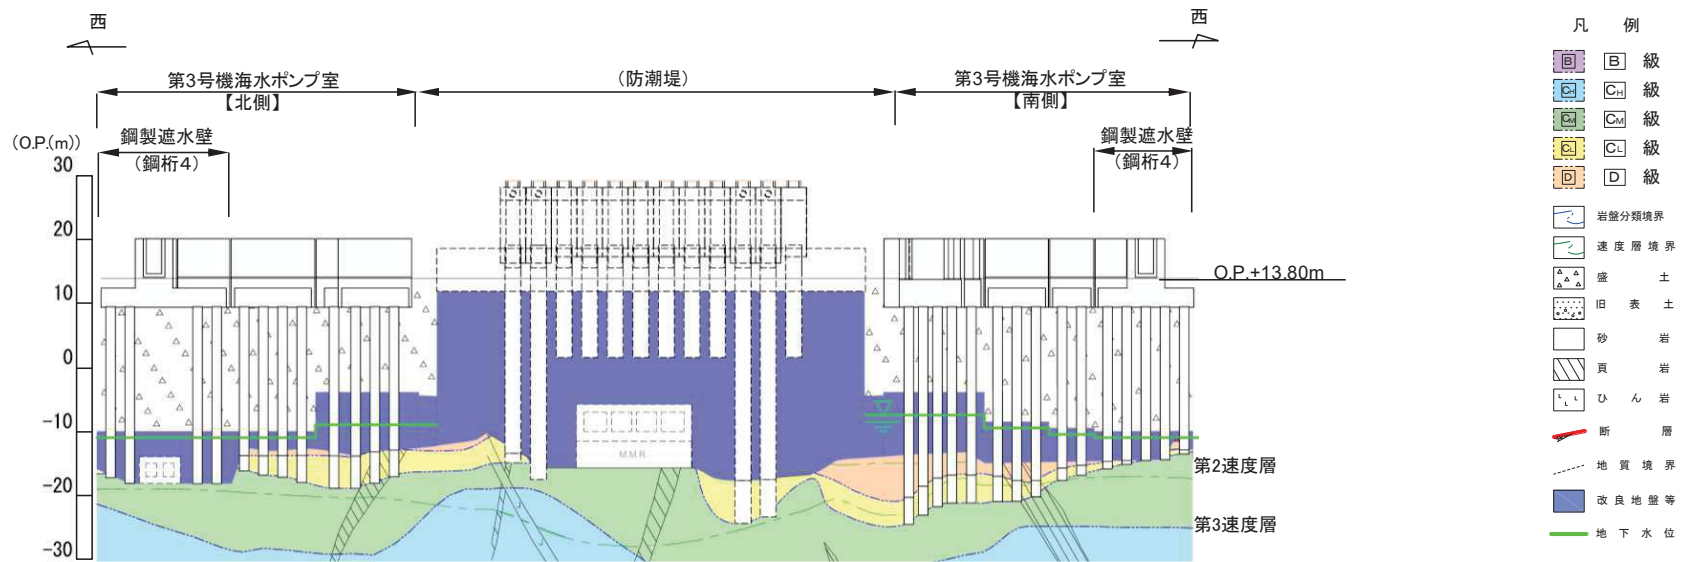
(3) 鋼製遮水壁(鋼桁)周辺の地質状況(第3号機海水ポンプ室)
